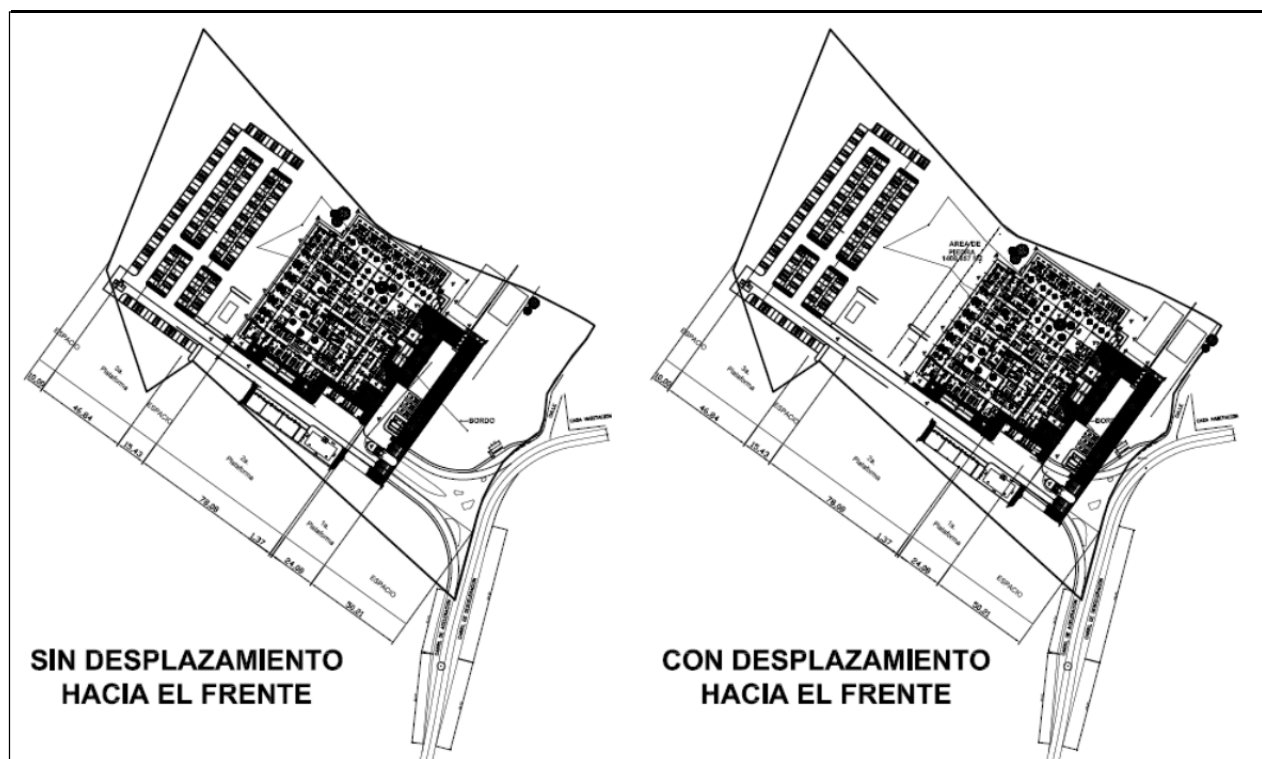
Vista de la propuesta original y su desplazamiento planteado
